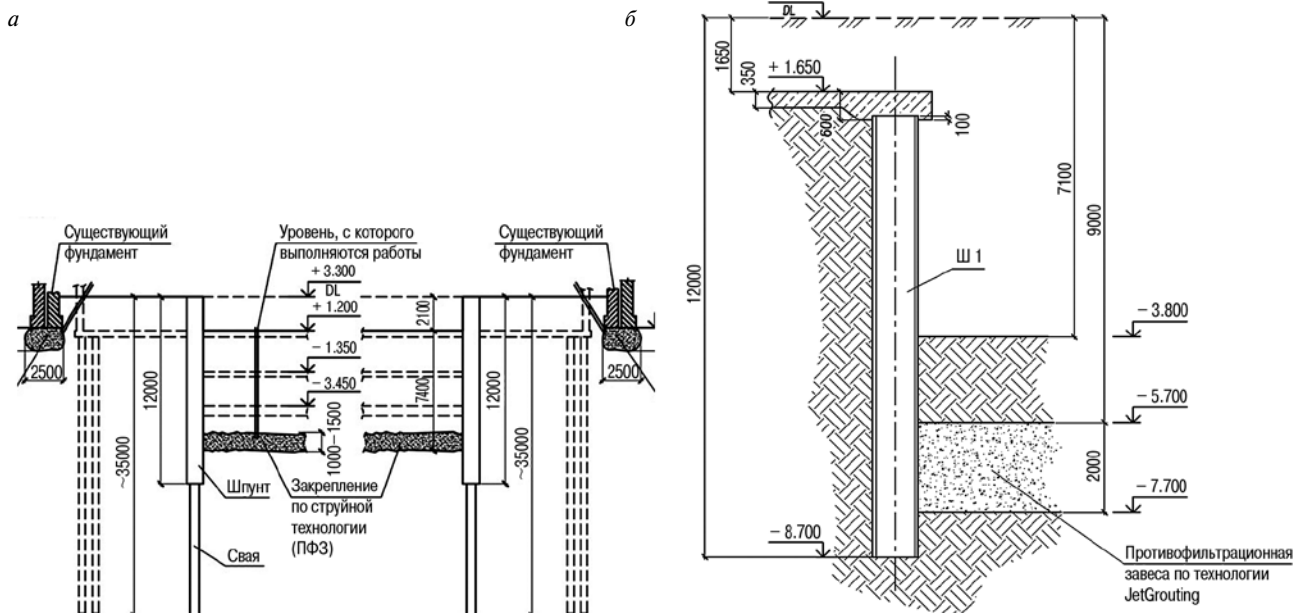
Схема устройства котлована паркинг-сейфа: а – поперечный разрез котлована; б – деталь
